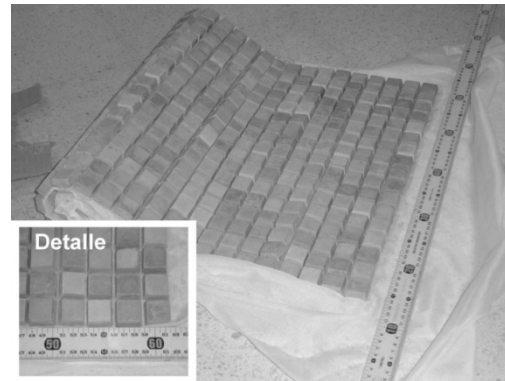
Protección de Bloques de Concreto Adherido a Geotextil.
